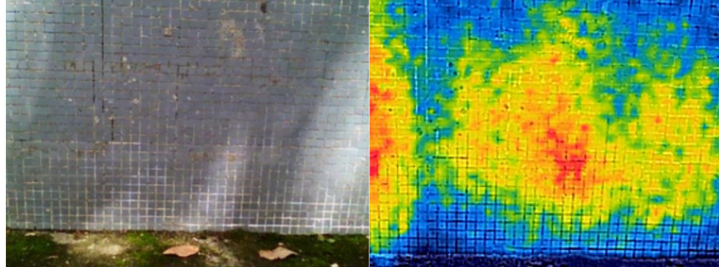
| Inspeção termográfica passiva realizada no sistema de revestimento em pastilha do primeiro pavimento da fachada norte do Pavilhão Arthur Neiva na data de 30 de outubro de 2023.
